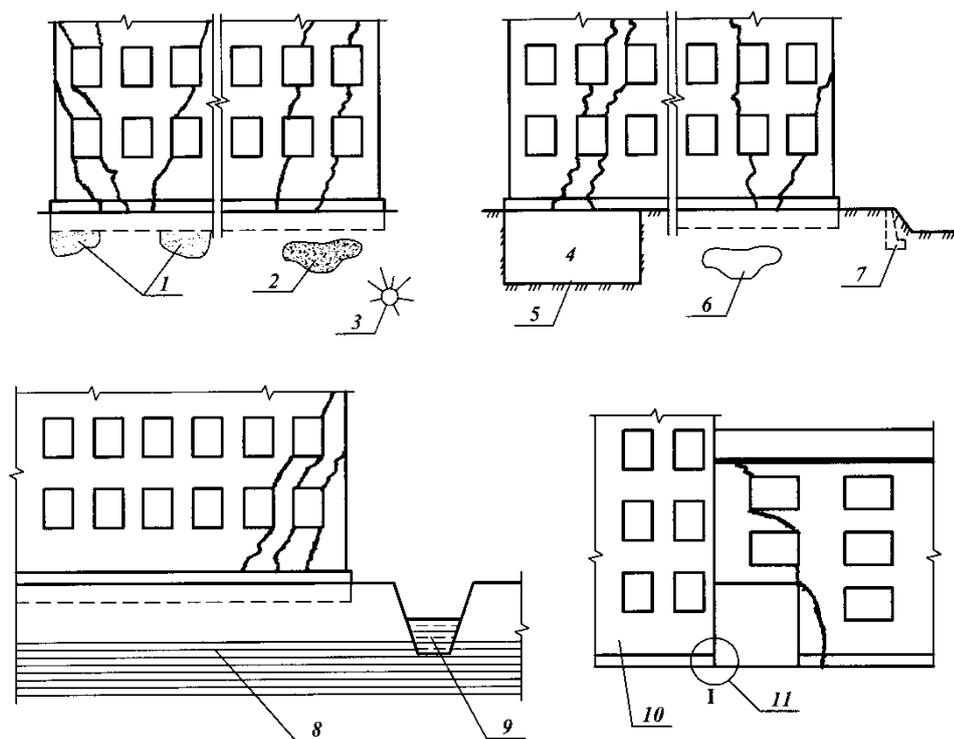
Осадочные трещины в конструкциях: 1 - слабые грунты; 2 - карст; 3 - прорыв водопровода; 4 - подвал; 5 - плотный грунт; 6 - жесткая опора; 7 - сдвиг подпорной стенки; 8 - пилы; 9 - траншея; 10 - пристраиваемое здание; 11 - зона наложения дополнительных нагрузок
